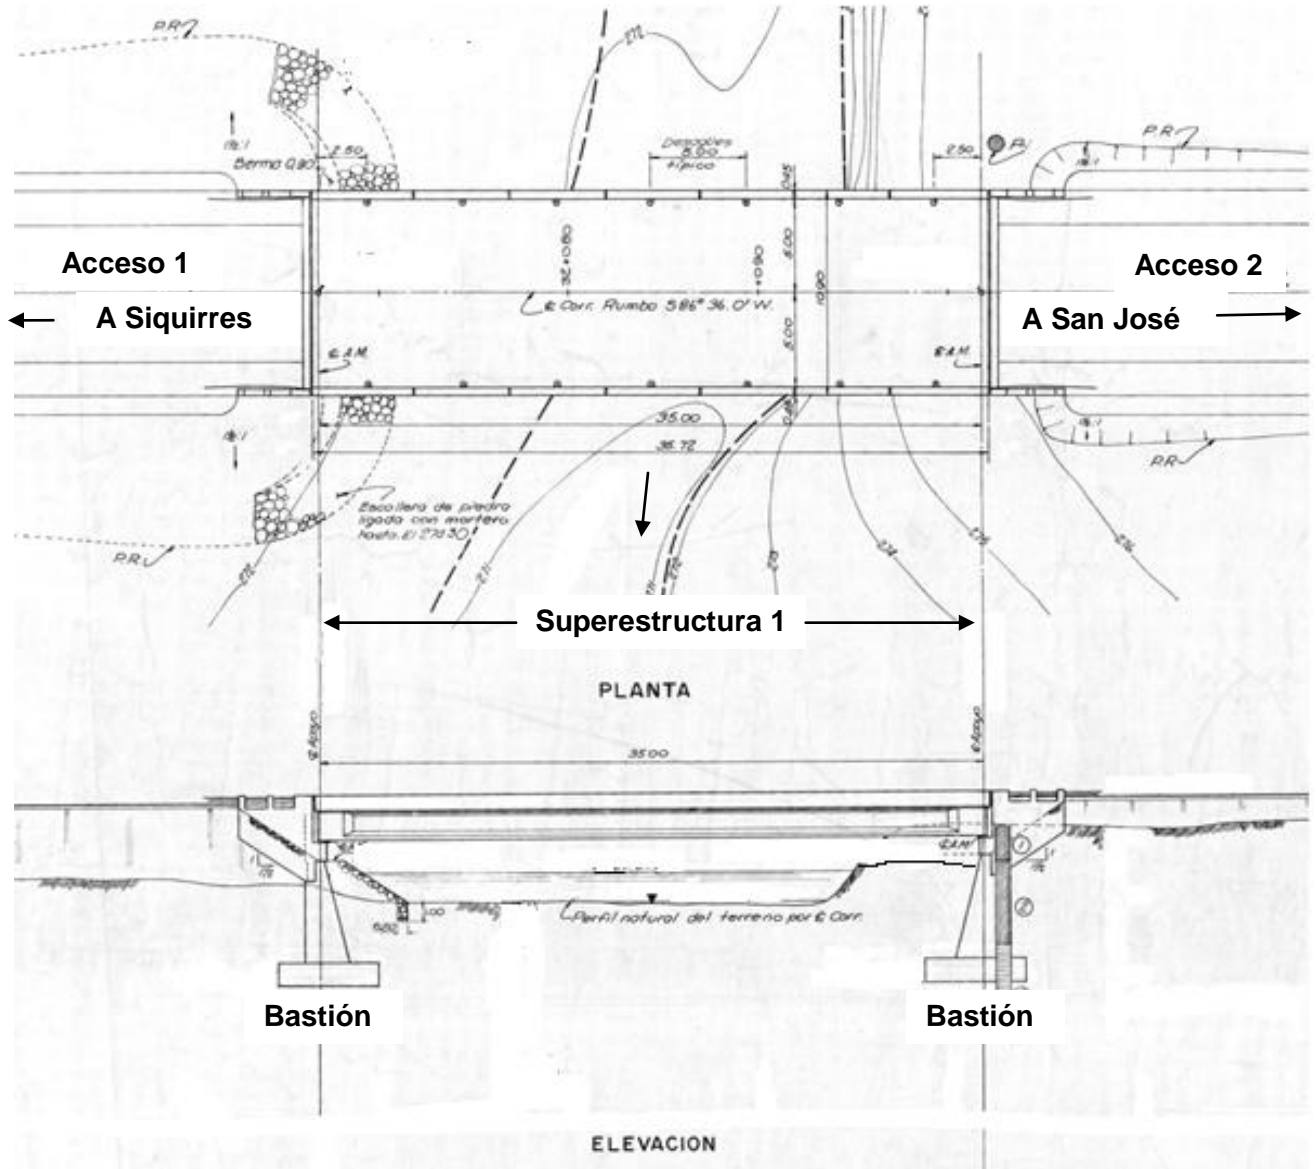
Figura D. Identificación utilizada para el puente sobre el Río Danta (el esquema no corresponde a los planos del diseño del puente).
